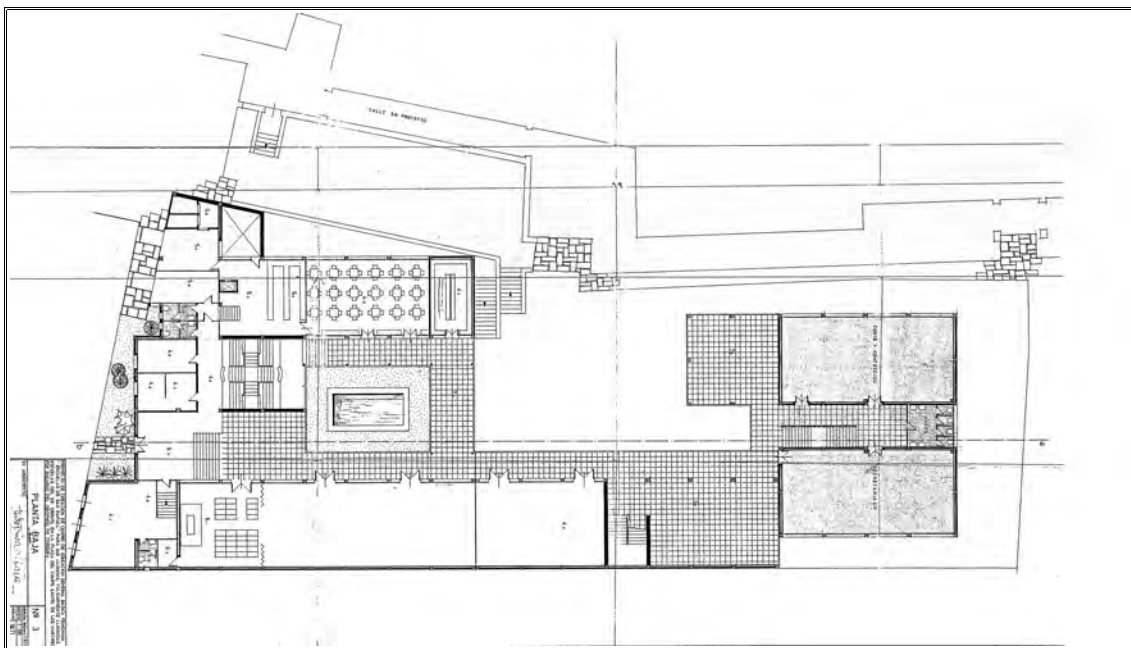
Planta baja de la “Escuelas de San Rafael”, por Carlos Luca de Tena. (APEALT, *Proyecto de Centro de Educación General Básica Femenina “Escuelas de San Rafael”*, Plano Núm. 3, 1971).
